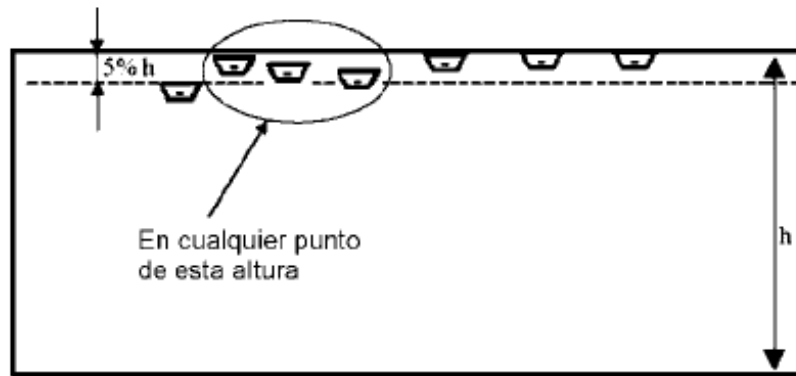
Emplazamiento y separación bajo falsos techos
